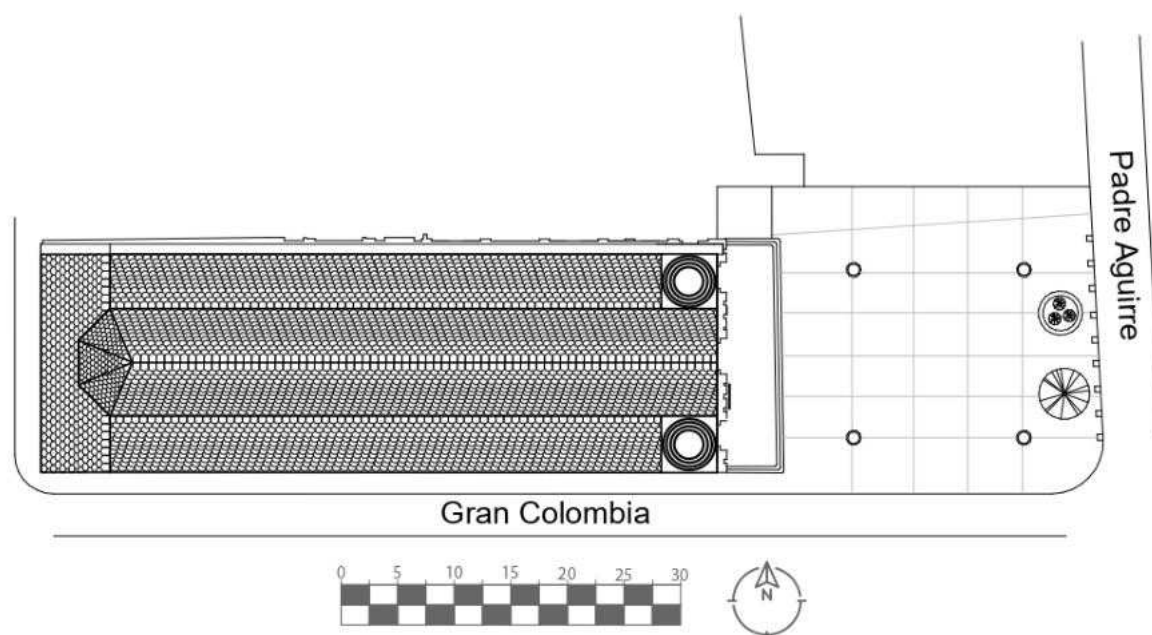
Emplazamiento de la Iglesia de Santo Domingo. Fuente y Elaboración: Autora
